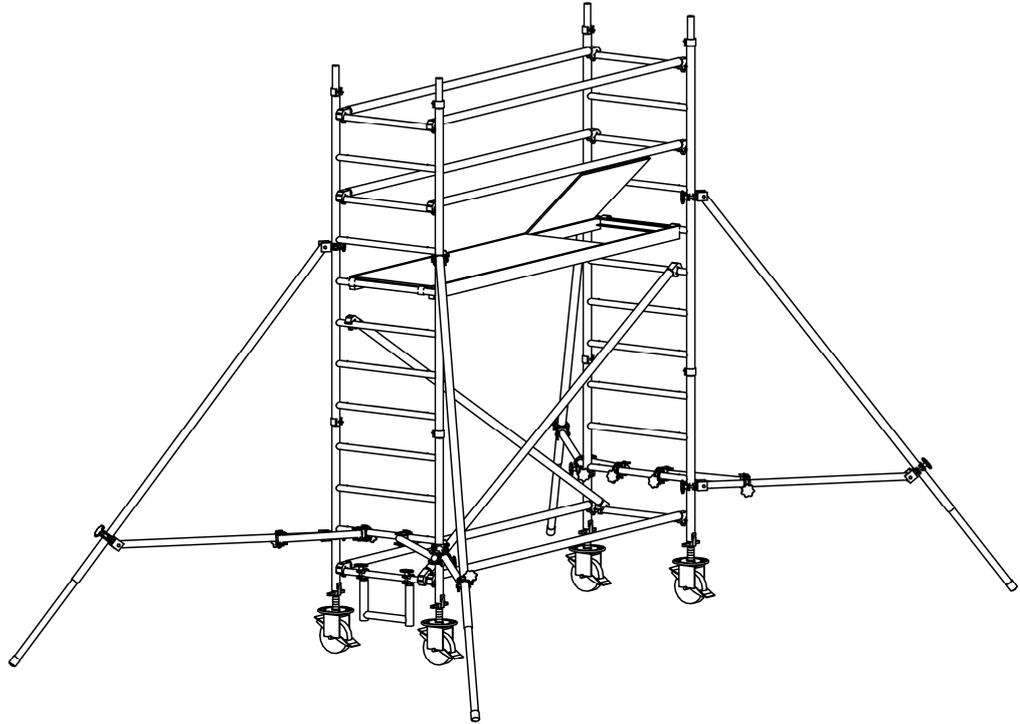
Aufbau mit Alu-Gerüststütze, Standhöhe 2.25 m
